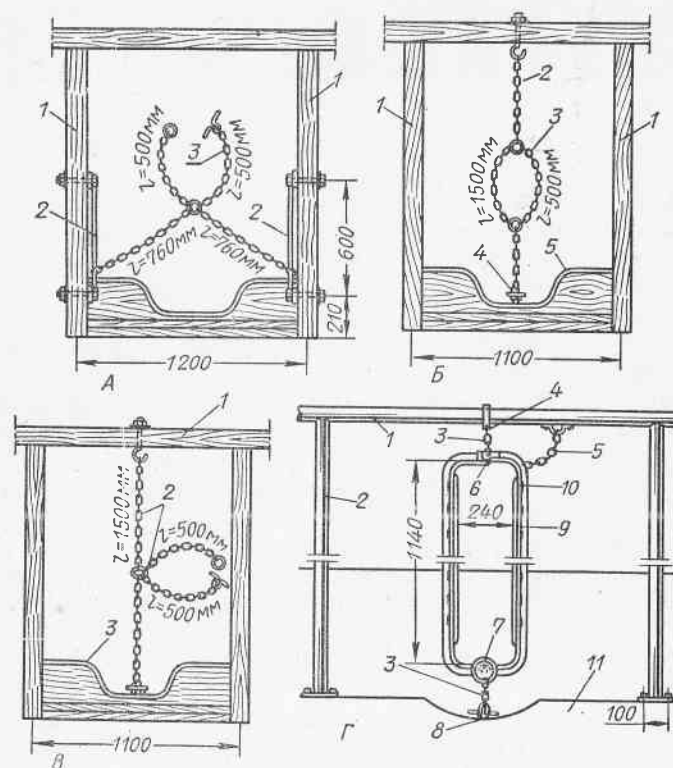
Схема привязей для крупного рогатого скота: А — четырехконцовая цепная привязь для быков; 1 — стойка рамы; 2 — скоба; 3 — концы цепи; В — короткая цепная привязь для коров; 1 — стойка рамы; 2 — цепь длинная; 3 — цепь короткая; 4 — баранчик с кольцом; 5 — борт кормушки; Г — привязь цепная со скользящим ошейником; 1 — стойловая рама; 2 — цепи; 3 — борт кормушки; Г — хомутовая привязь; 1 — труба; 2 — стойка; 3 — цепь; 4 — хомут; 5 — ограничительная цепь; 6 — замок-крючок; 7 — шарнир; 8 — скоба; 9 — деревянная планка; 10 — боконы (стальной уголок); 11 — кормушка.
